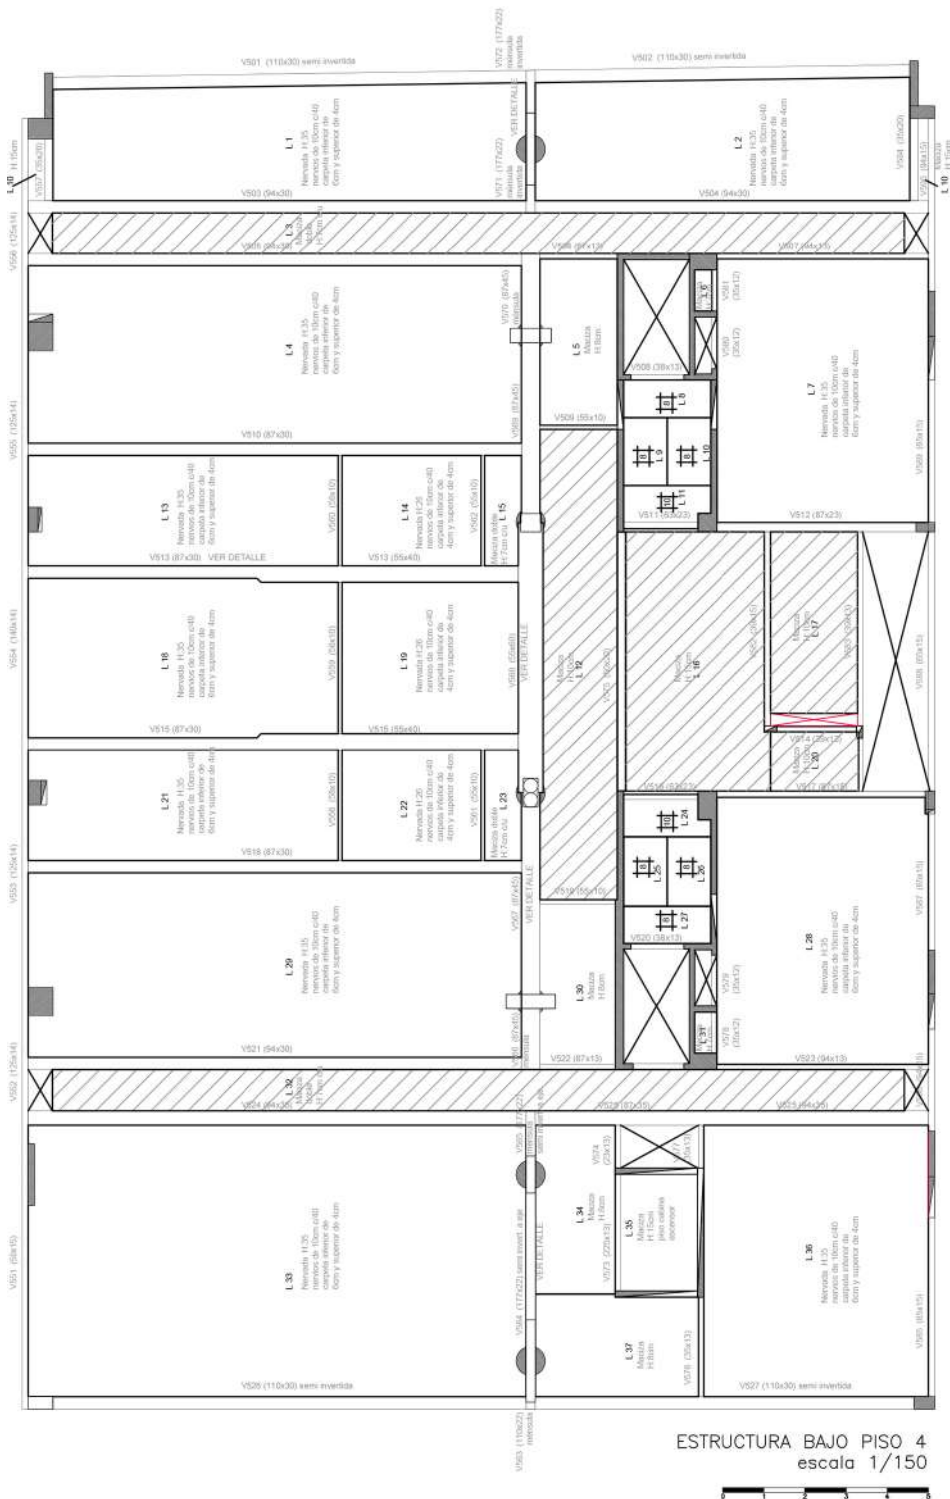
Planta de la estructura construida del BCLA atravesando el nivel 4. Se aprecia la espina estructural conformada por los núcleos, los cambios de sección de la columnata central y las alteraciones morfológicas de las vigas para salvar las luces hacia los extremos del predio.
